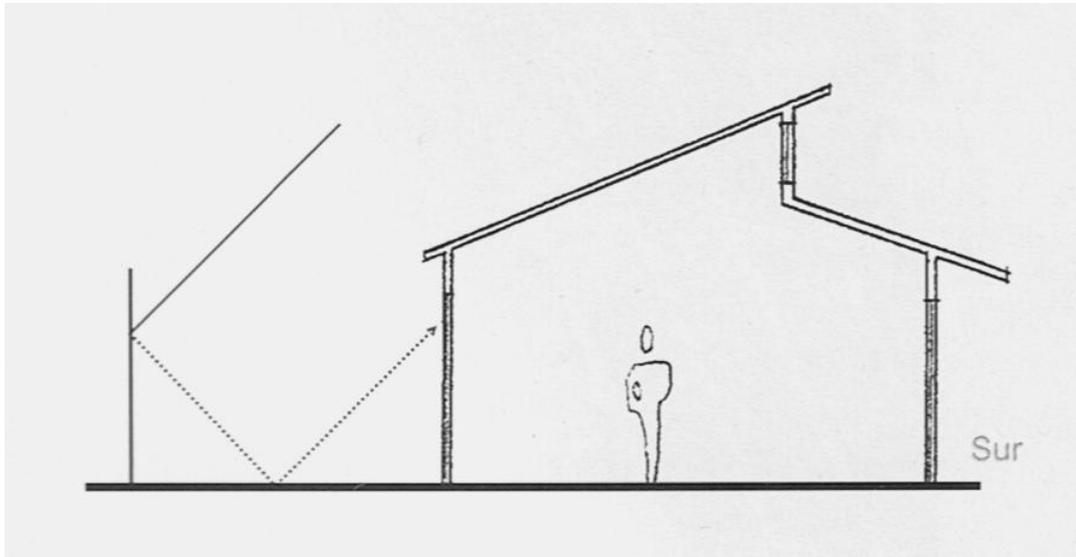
Rebote de la insolación hacia la edificación.
